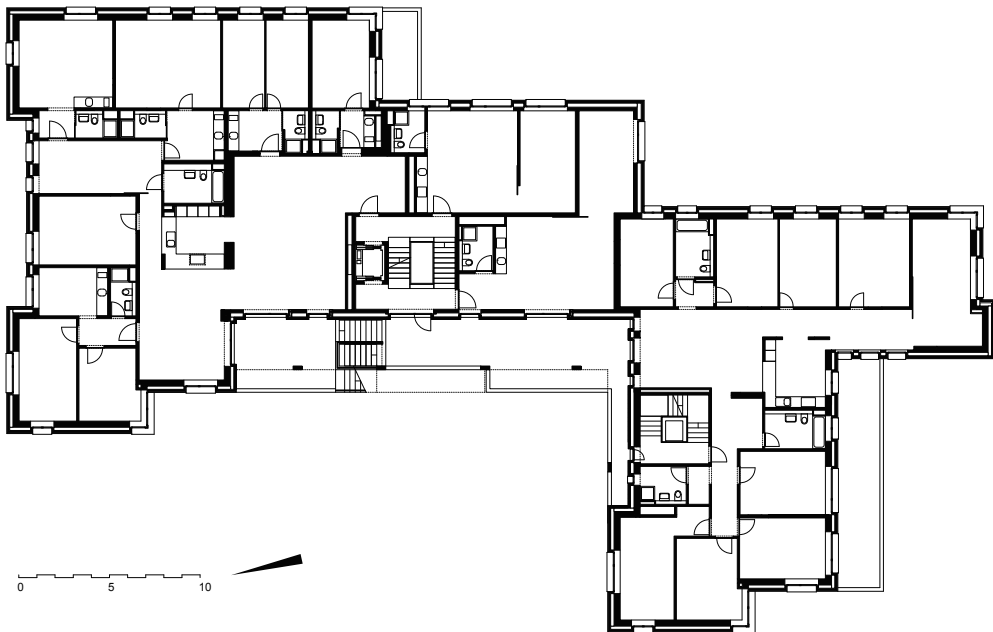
Kraftwerk1 Heizenholz, Grundriss Clusterwohnung, Kleinwohnungen und Wohngemeinschaft Adrian Streich Architekten Zürich
